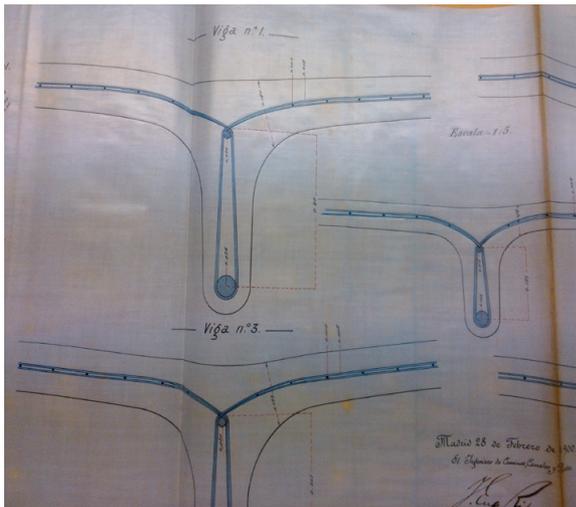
Detalles de los planos de la solución de depósito circular sistema Monier. 1900. Archivo Municipal de Gijón. Expediente N° 132.
